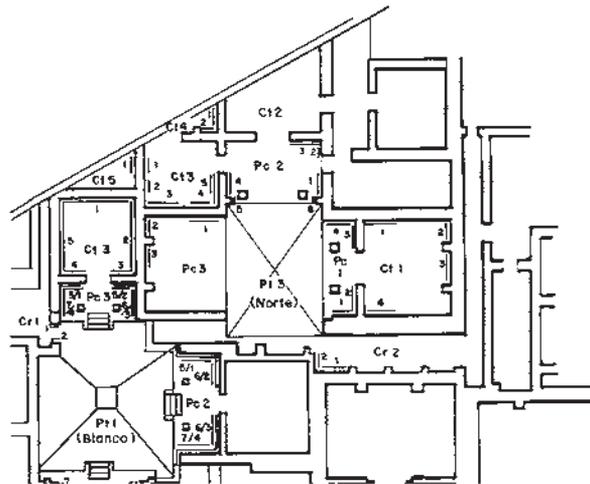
Plano del Conjunto "C" o Patio norte de Atetelco.
